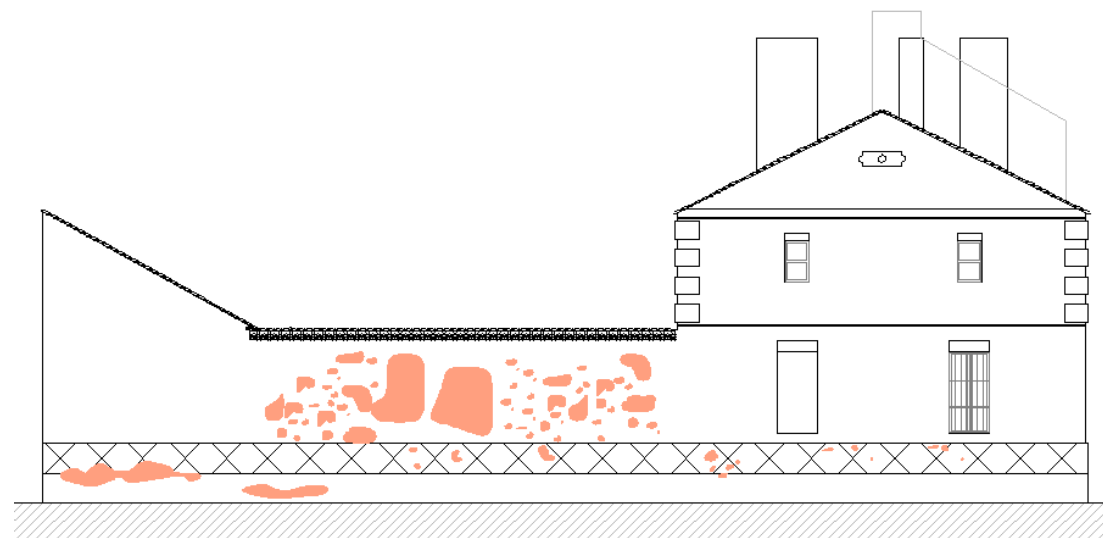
Plano fachada Sud-Oeste (Fuente propia)
